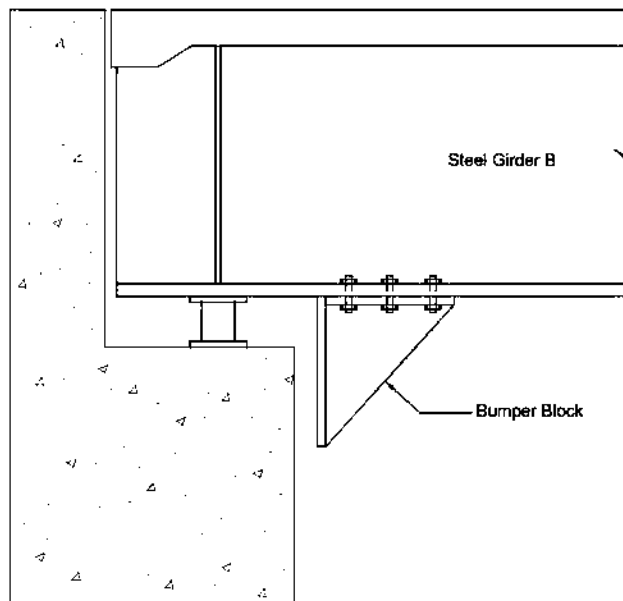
Reductor bumper blocks (Buckle et al, 2006)
